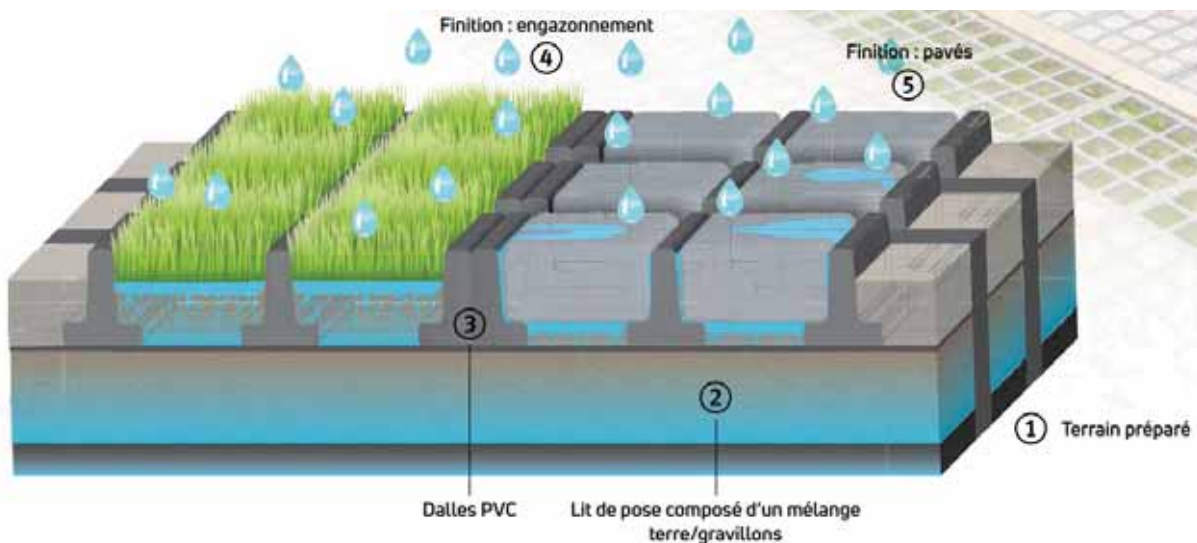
Schéma d'un exemple de dalles pavées engazonnées et de dalles pavées béton – ADOPTA
